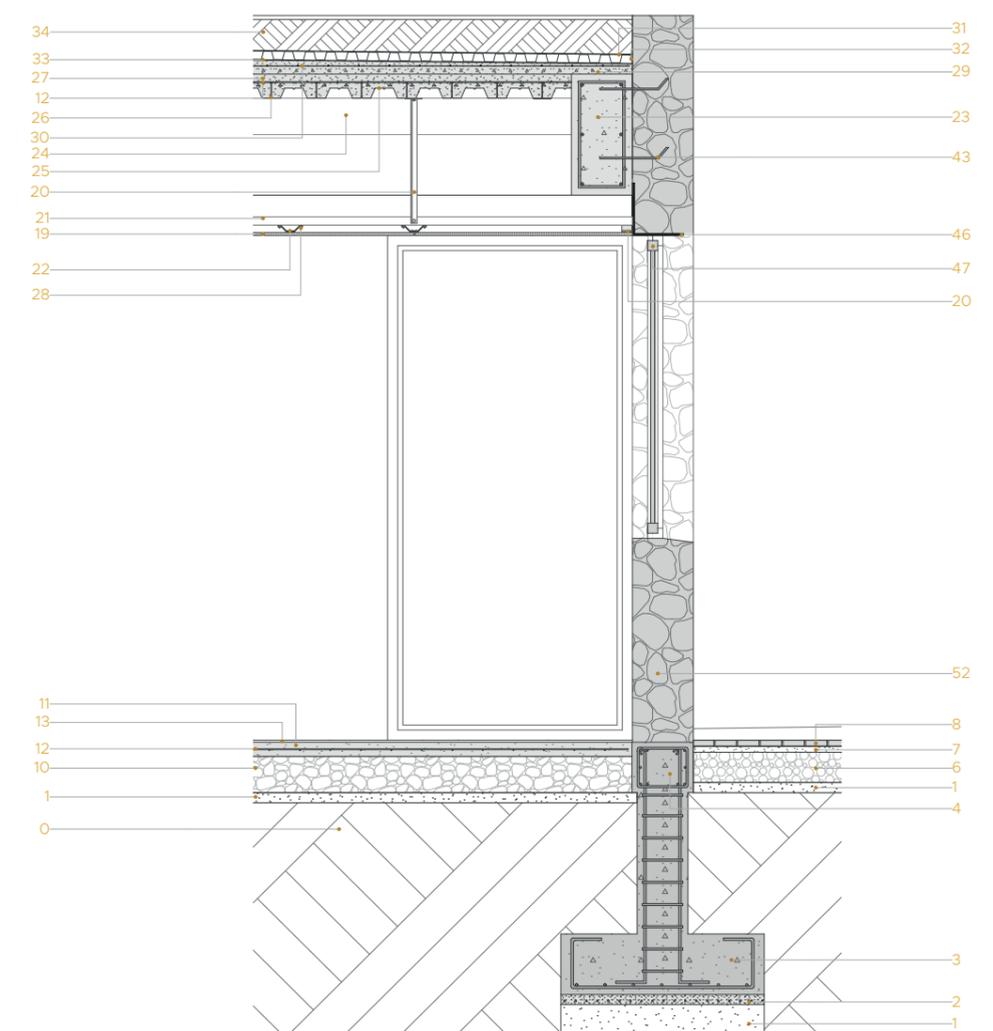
\_C4: sección constructiva\_03, muro portante de piedra, zona administrativa
